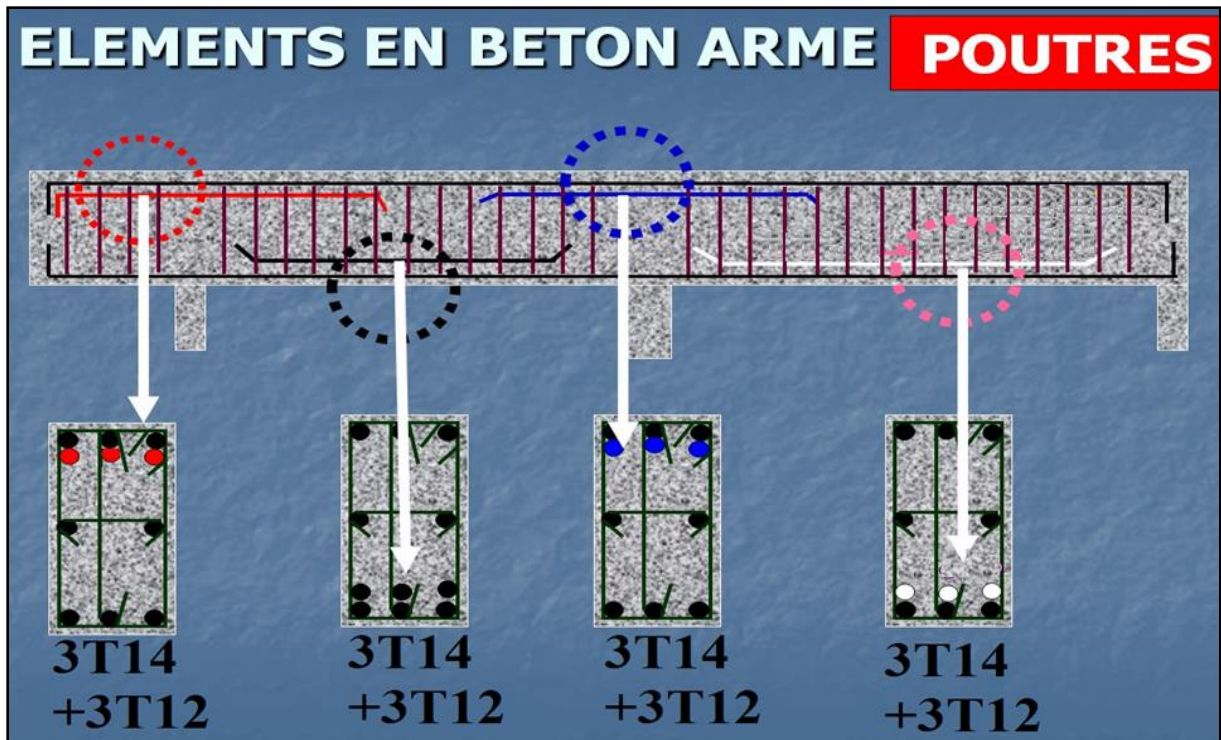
Ferrailage des poutres principales du bloc A1 de siège APC.
